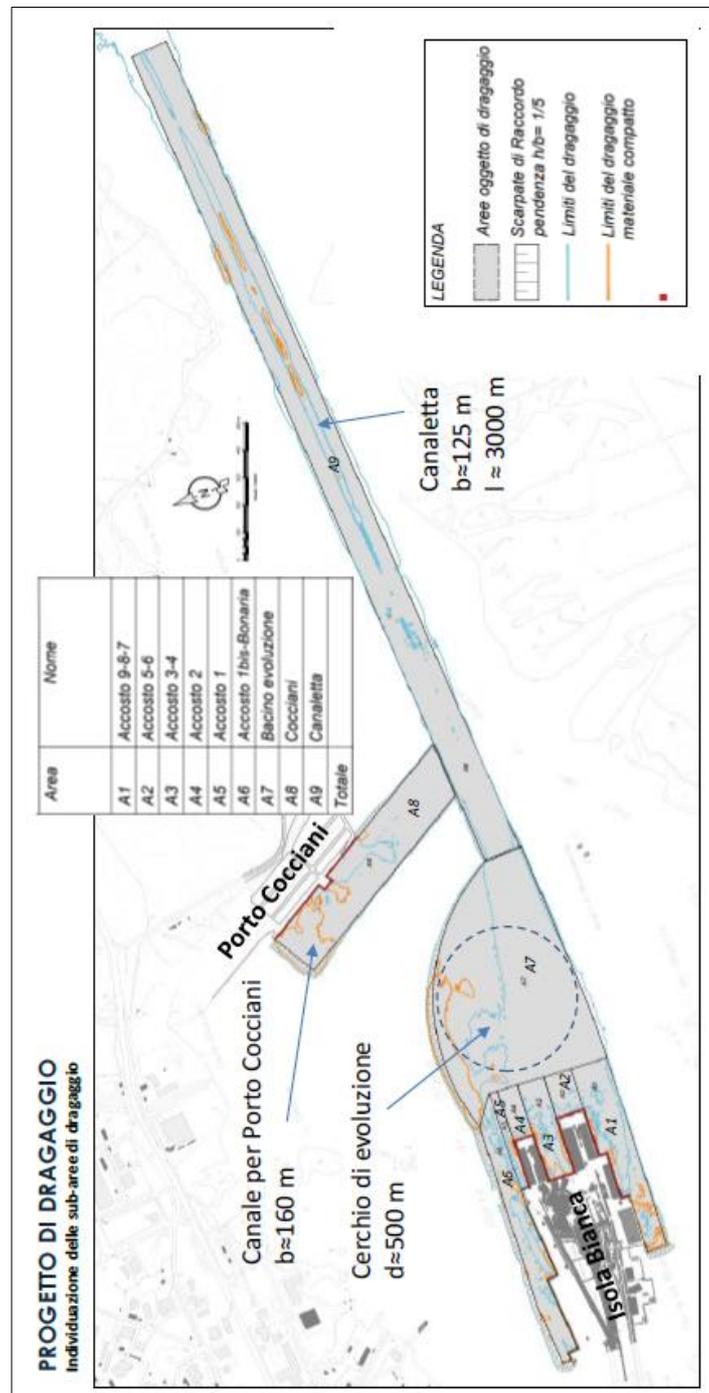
Planimetria generale di progetto con le 9 sub-aree di dragaggio (estr. da Rel. Gen. PFTE 2023: fig. 1-2).
